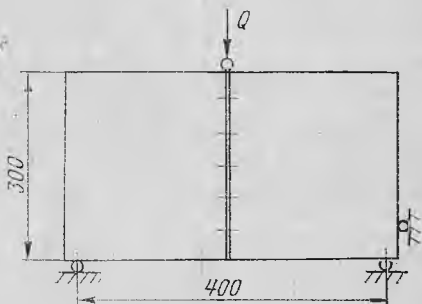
Схема испытания узловых соединений при действии вертикальных нагрузок.
